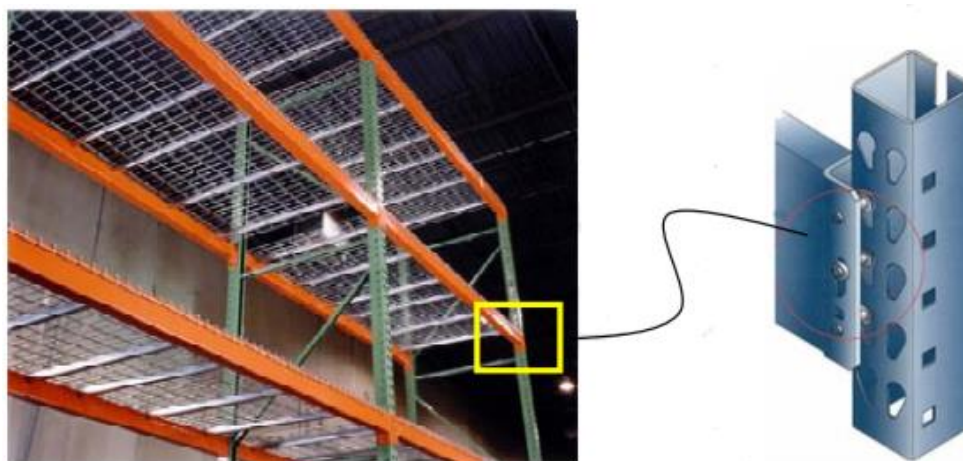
Perfurações em colunas de armazenamento em sistemas estrutural porta-pallets.
